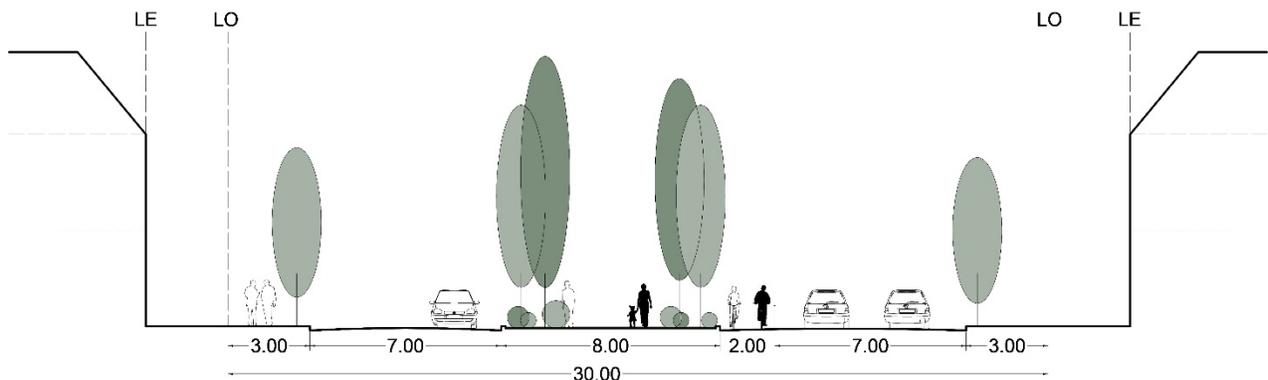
Perfil esquemático de avenidas arboladas - Fuente: Elaboración propia
